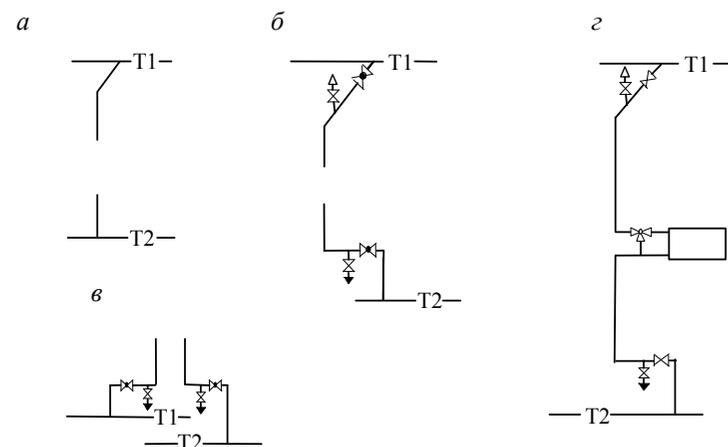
Схемы присоединения стояков к магистралям систем отопления двух-, трехэтажных зданий (а), четырех-, семиэтажных при верхней разводке (б) и при нижней разводке (в), восьмиэтажных и более высоких зданий (г)
